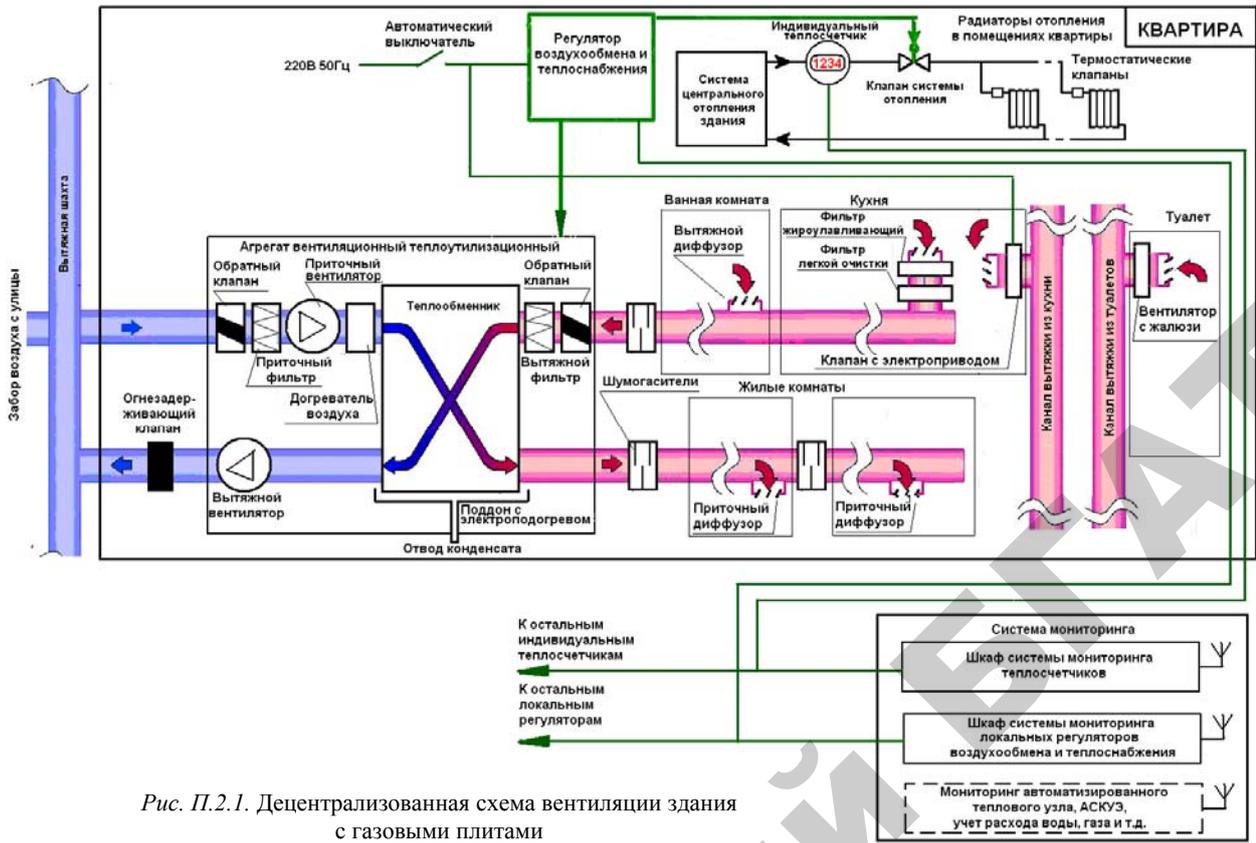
Децентрализованная схема вентиляции здания с газовыми плитами
